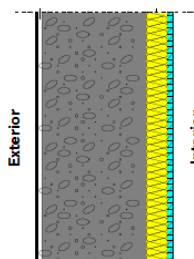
Pormenor das paredes exteriores – Par\_Ext\_4.
